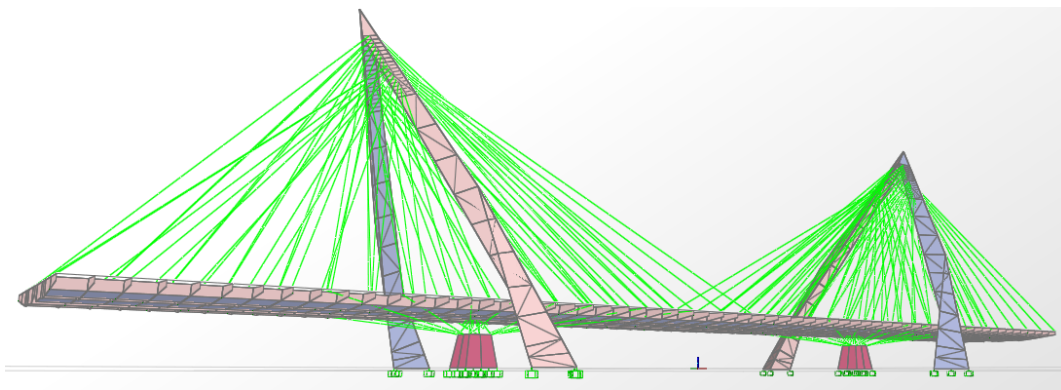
Isométrico del puente con amortiguadores y cables pretensados bajo la cubierta
